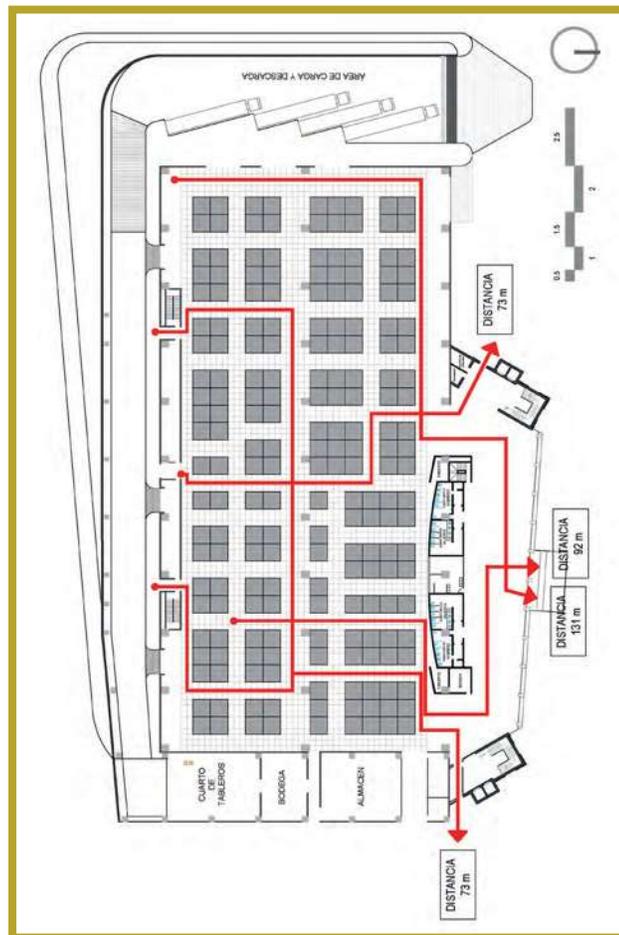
Rutas vigentes de evacuación.²⁸ (Ver apartado planimetría)
